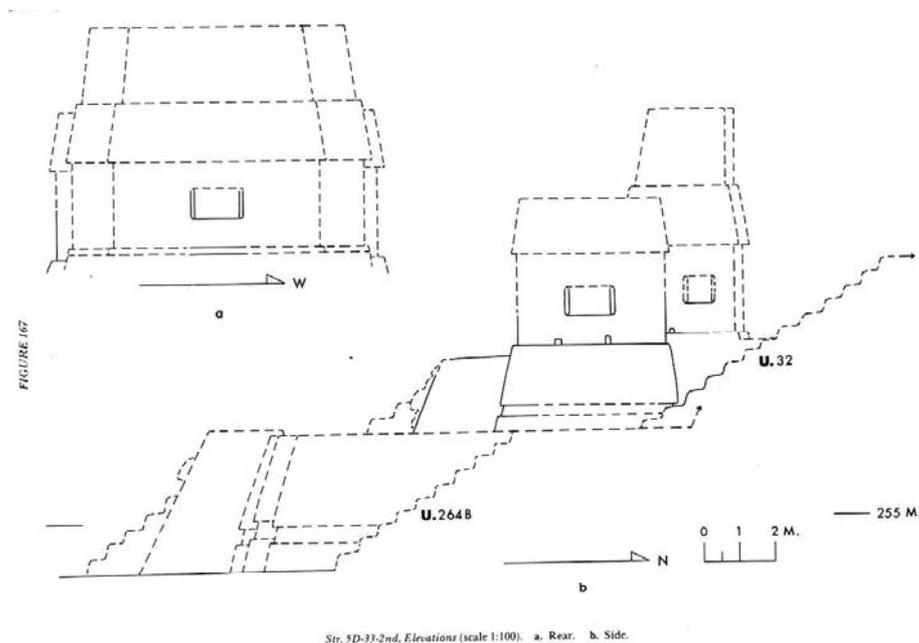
, Estr. 5D-33, 2ª Fachada Este con reconstrucción hipotética. Fuente: Tikal Report No. 14
